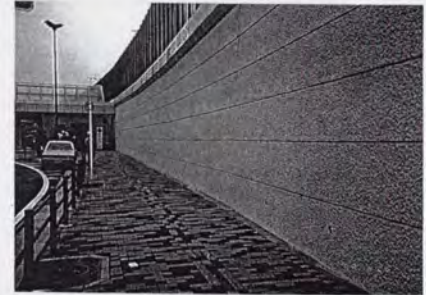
施工完了 (六地蔵駅No. 4)
